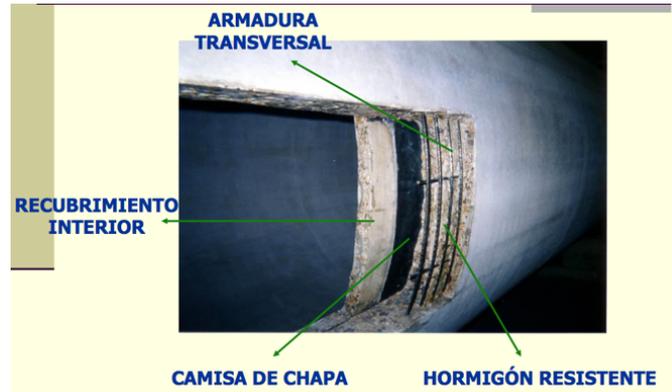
Detalle tubería de hormigón con camisa de chapa
